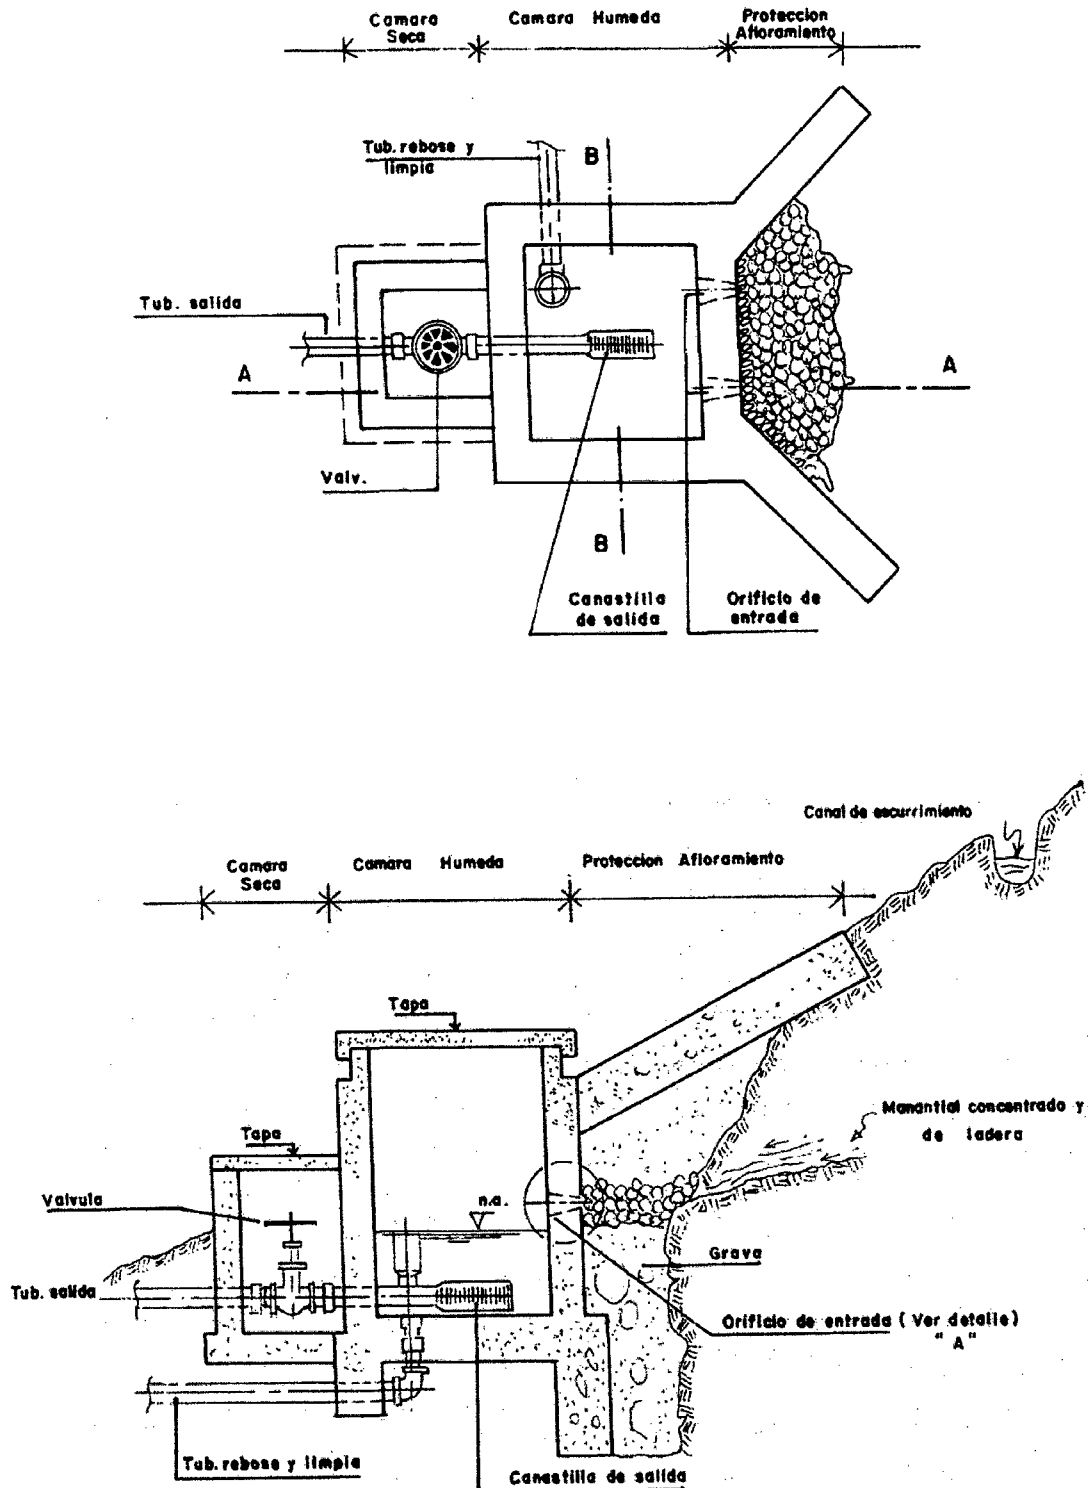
PLANTA Y PERFIL DE CAPTACION DE LADERA
